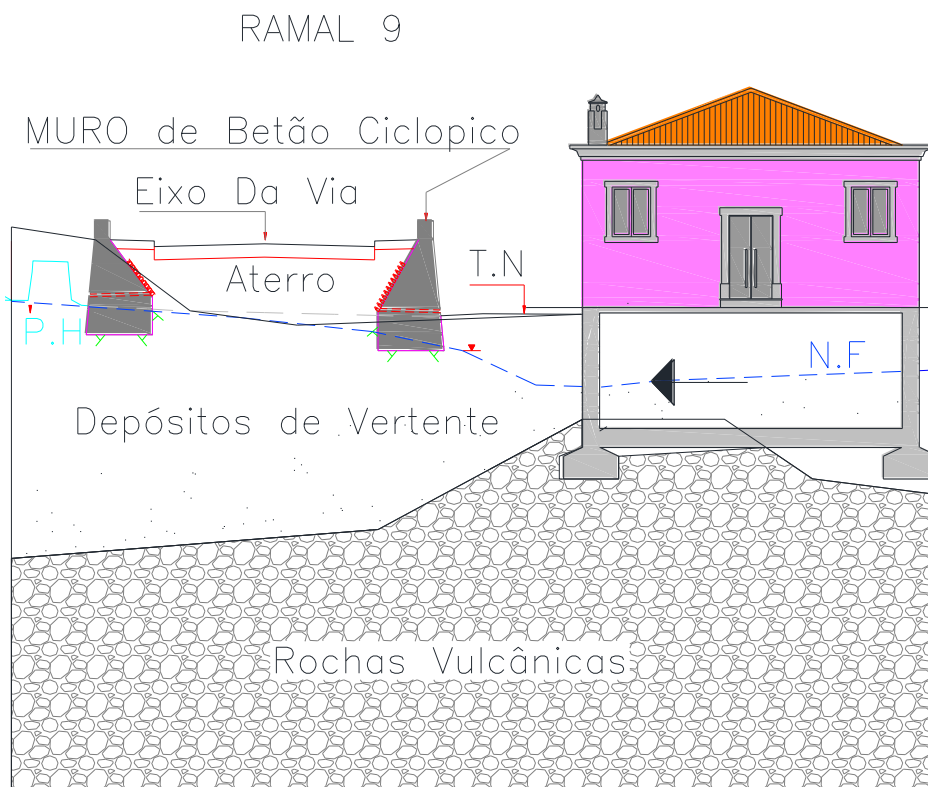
Esquema das fundações ligadas por vigas de fundação.
